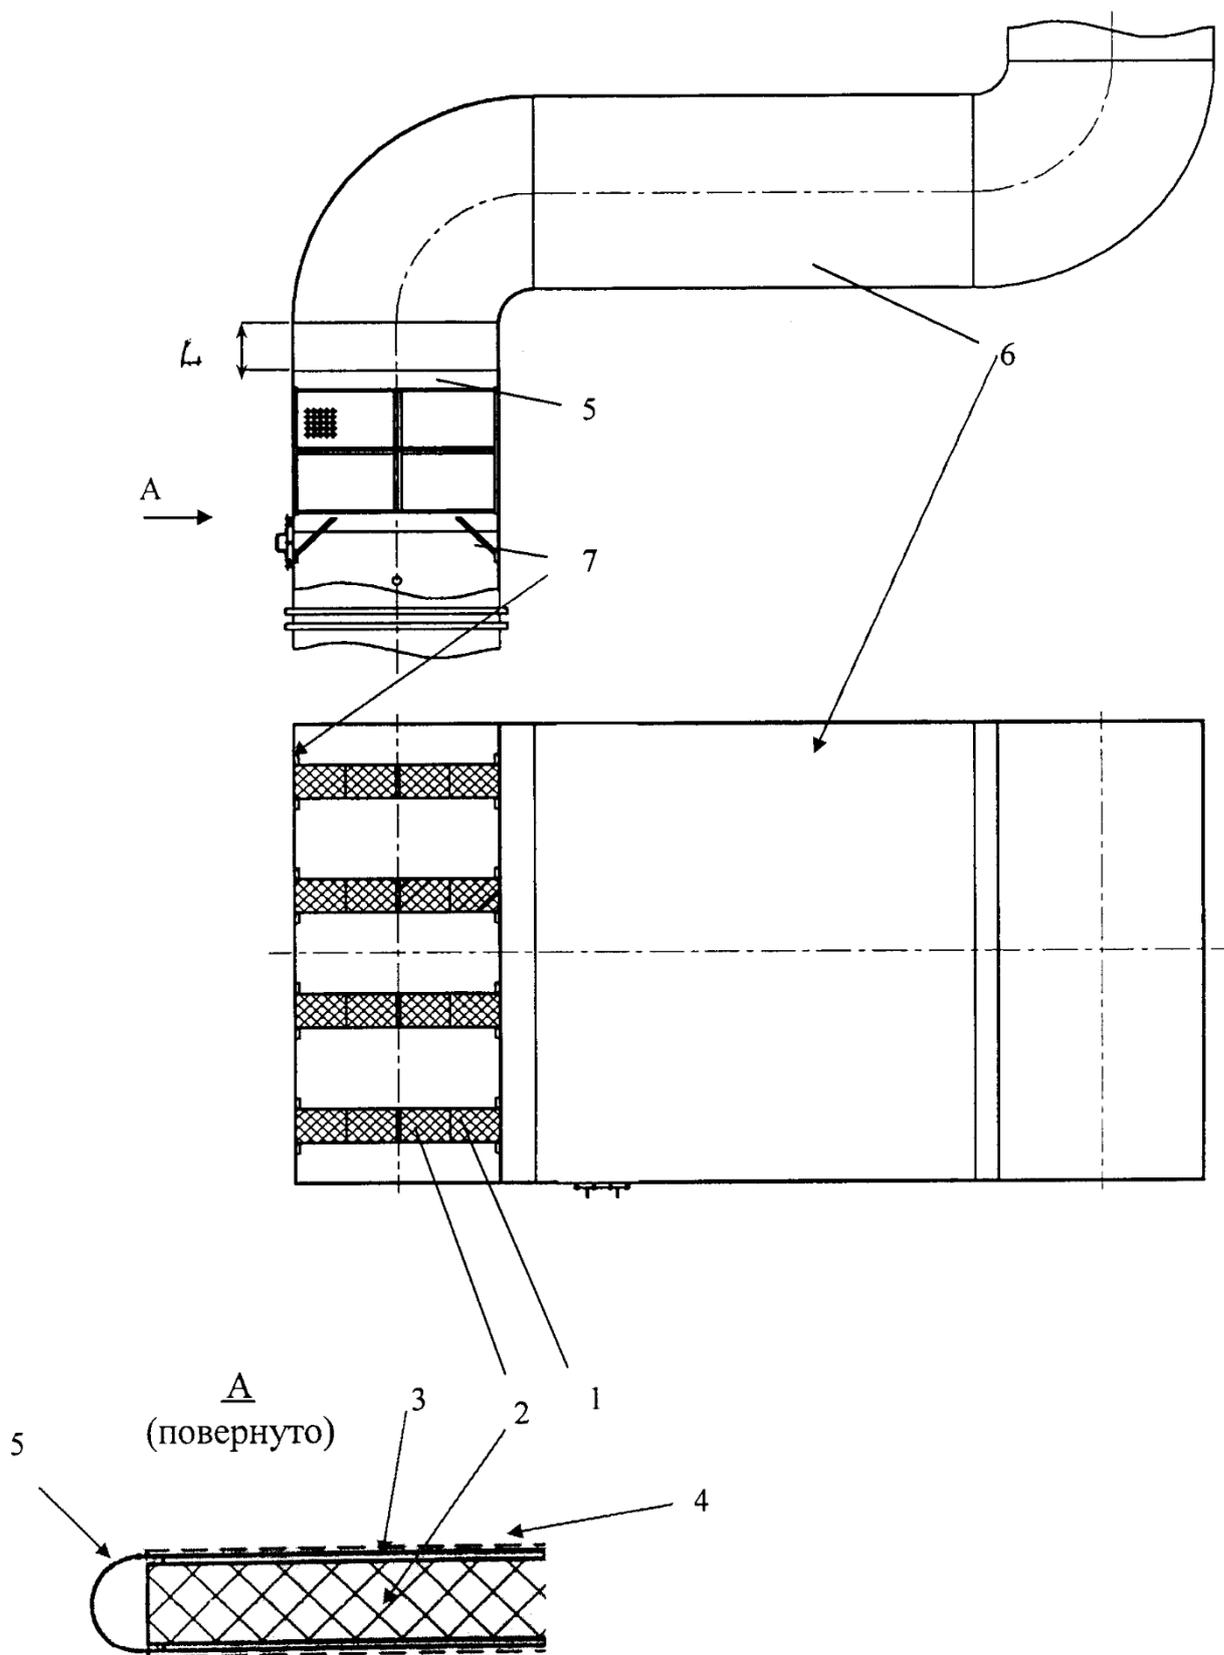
Пластинчатый глушитель в канале с поворотом, расположенный до поворота
